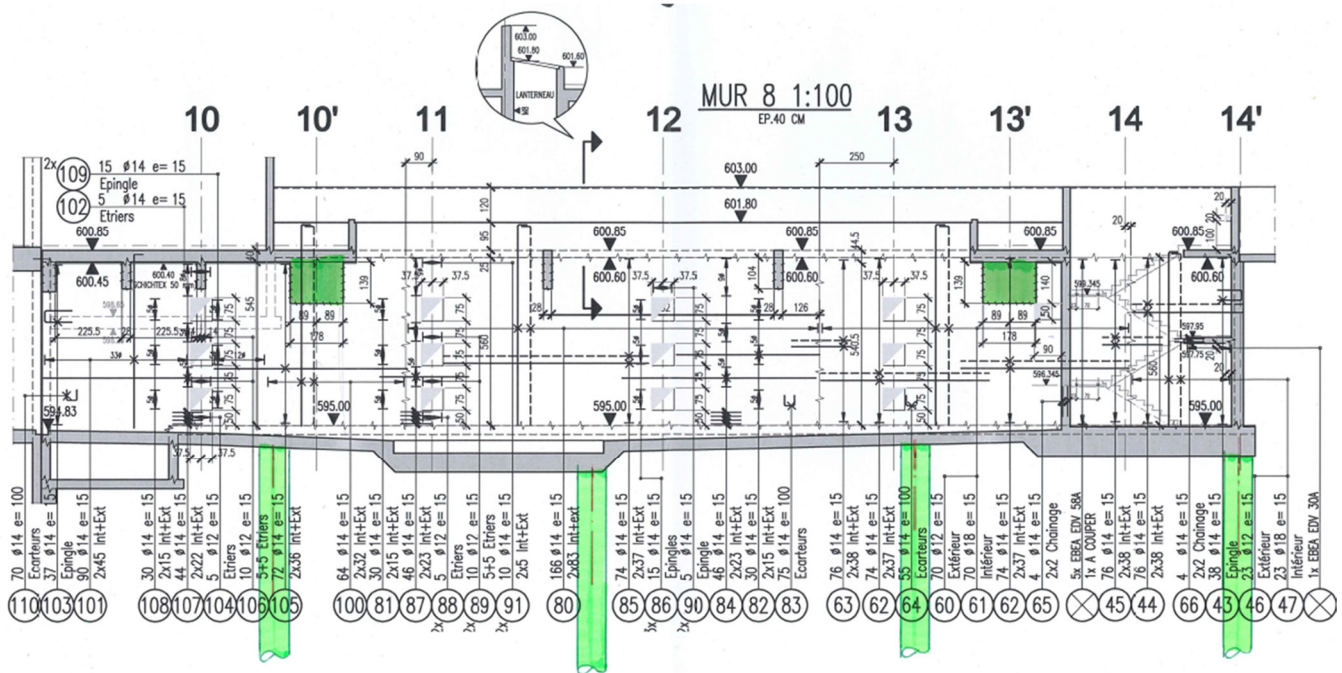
Extrait du plan du mur du fond de la gare actuelle
